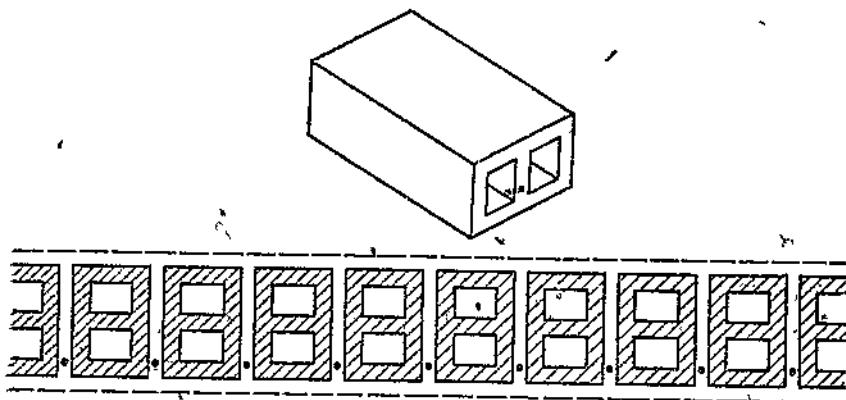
38. Потолочные перекрытия из керамических блоков.
